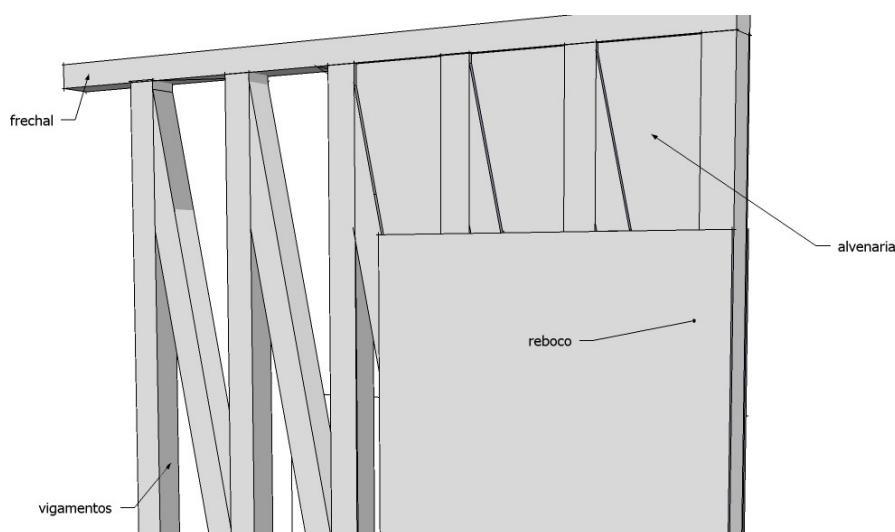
Sistema construtivo com vigamentos na vertical e na diagonal e enchimento em alvenaria.
